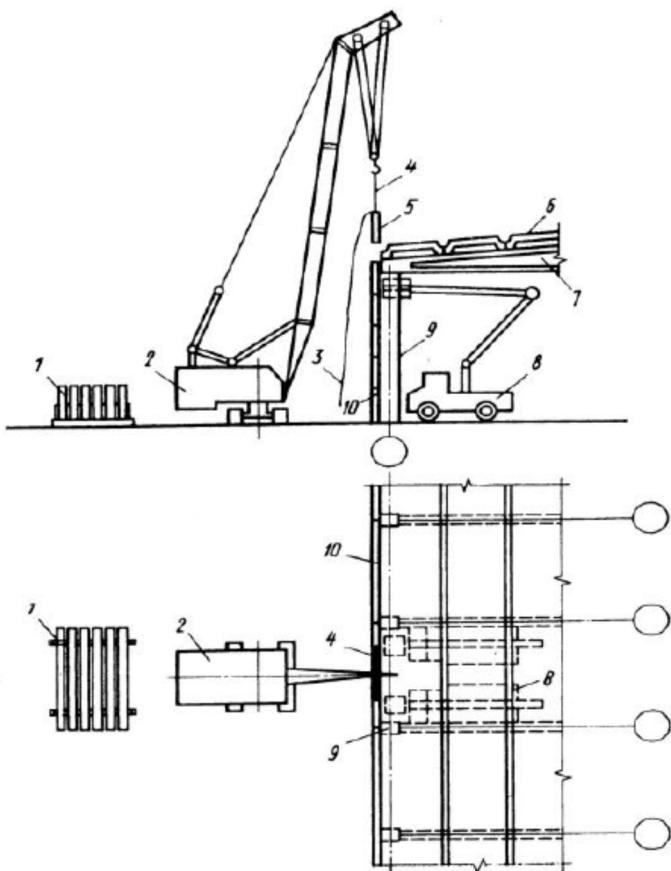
Схема монтажа стеновых ограждающих панелей, кран расположен между кассетой и стеной: 1 - кассета для складирования панелей стен; 2 - монтажный кран; 3 - оттяжка из пенькового каната; 4 - двухветвевой строп; 5 - панель стены; 6 - смонтированное покрытие; 7 - стропильная ферма; 8 - монтажный гидроподъемник на автомобиле; 9 - колонна; 10 - стоечное ограждение.
